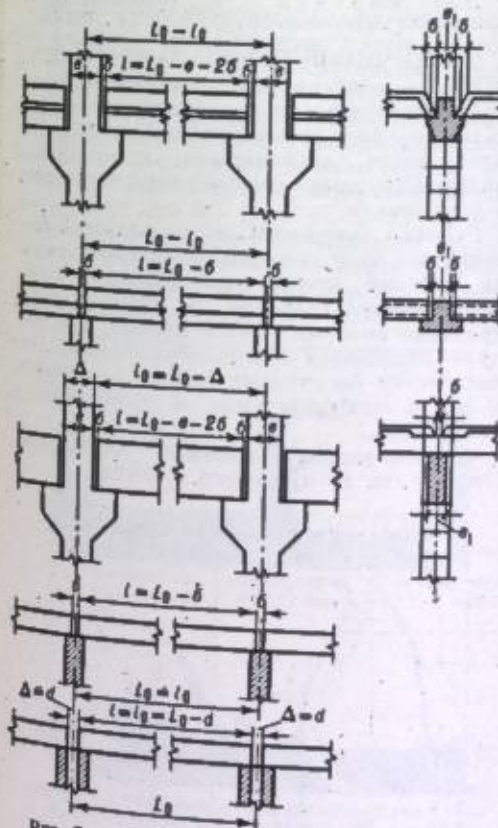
Примеры назначения номинальных и конструктивных размеров элементов: L_0 — объемно-планировочный параметр (шаг); L_0 — номинальный размер элемента; Δ — конструктивный интервал; l — конструктивный размер элемента; δ — нормированный зазор.
